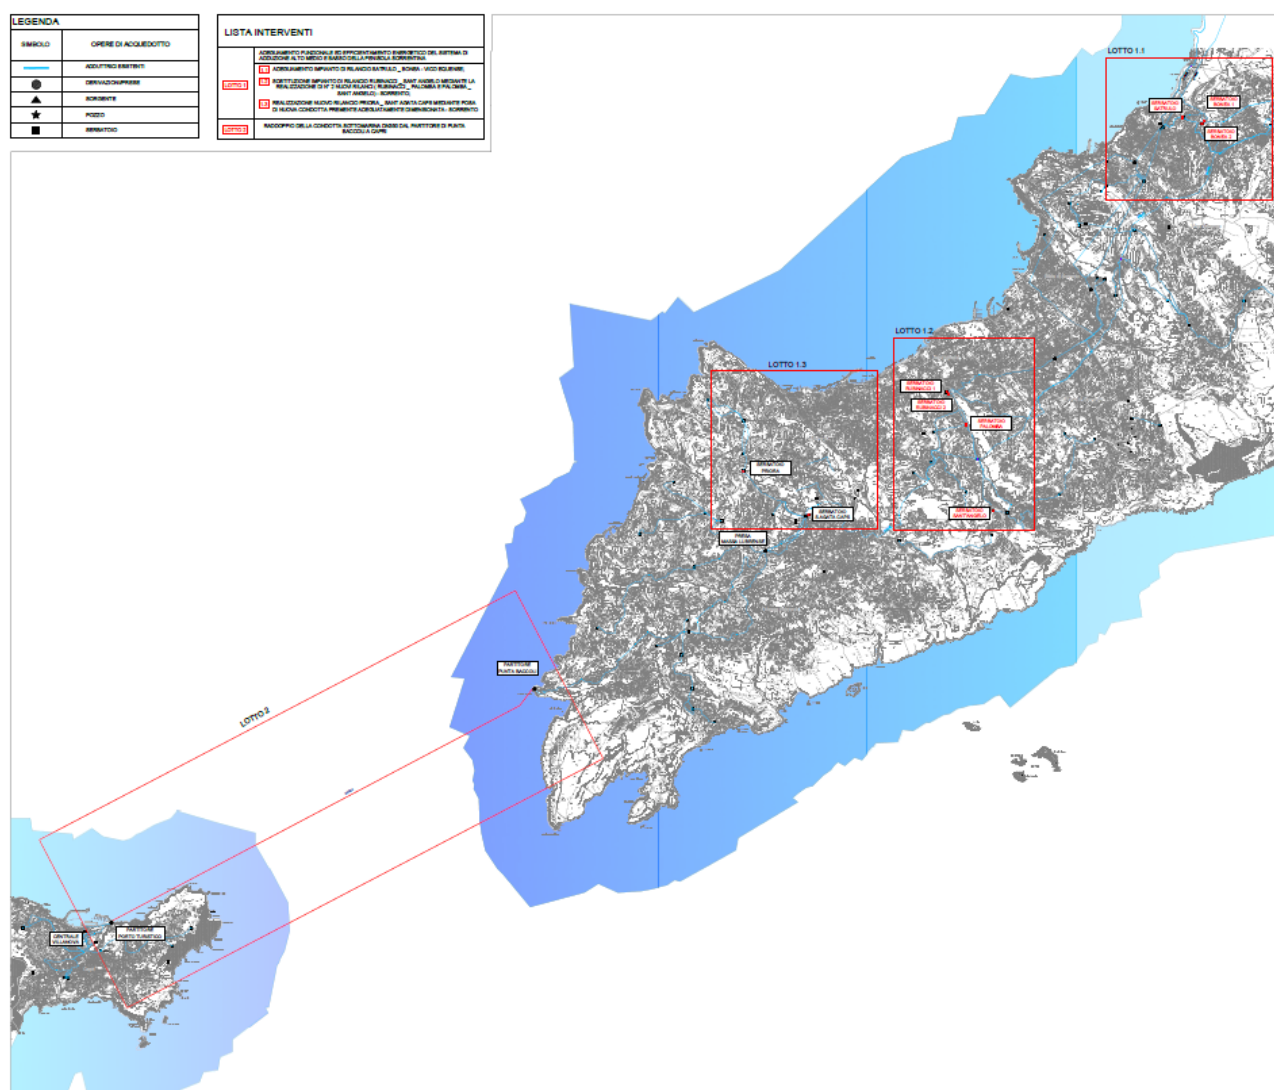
Planimetria degli interventi già oggetto di finanziamento
